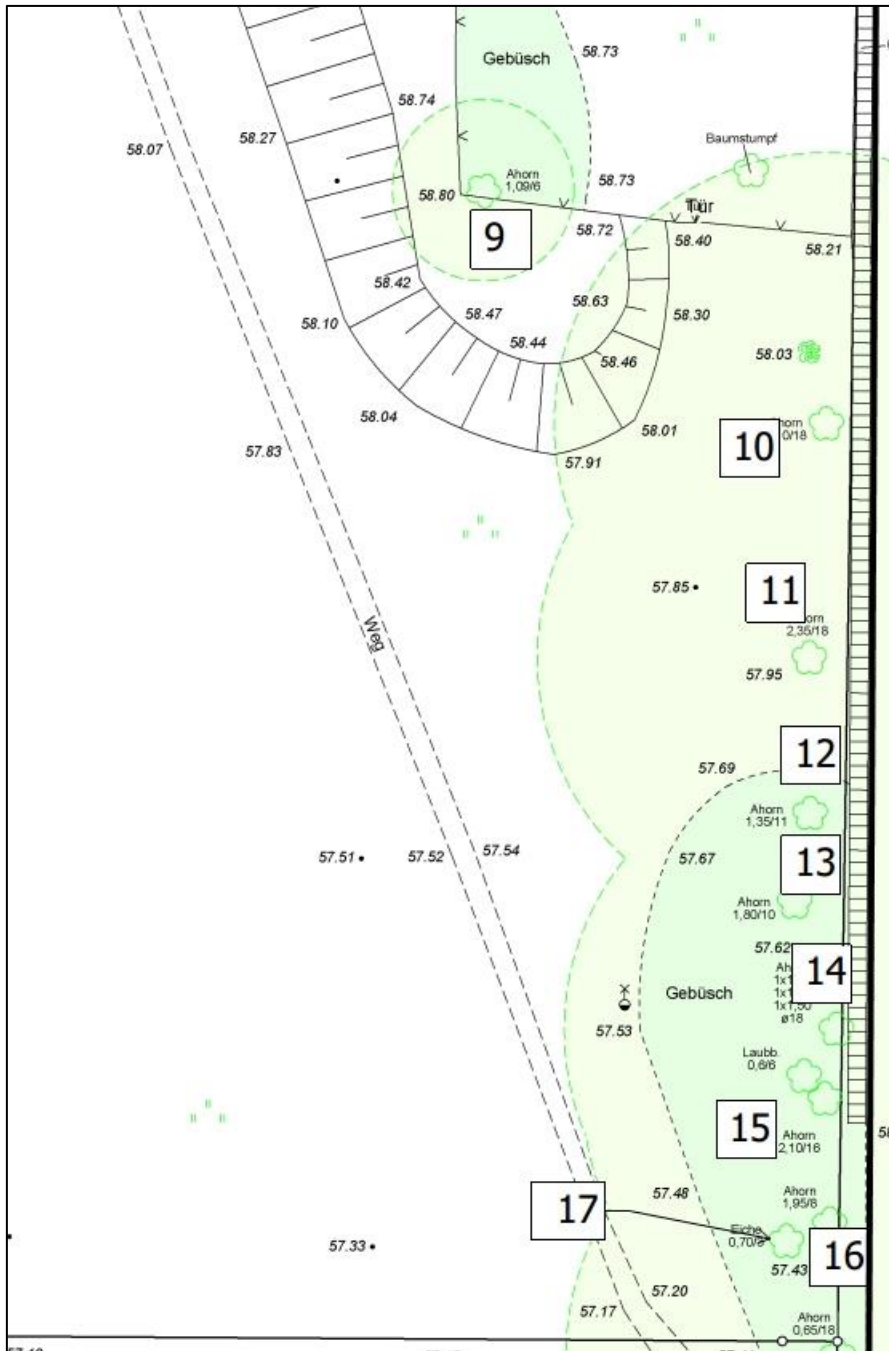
Baumbestand im geplanten WA IV, Grundlage: Vermesserplan (Stand 21.07.2020)
